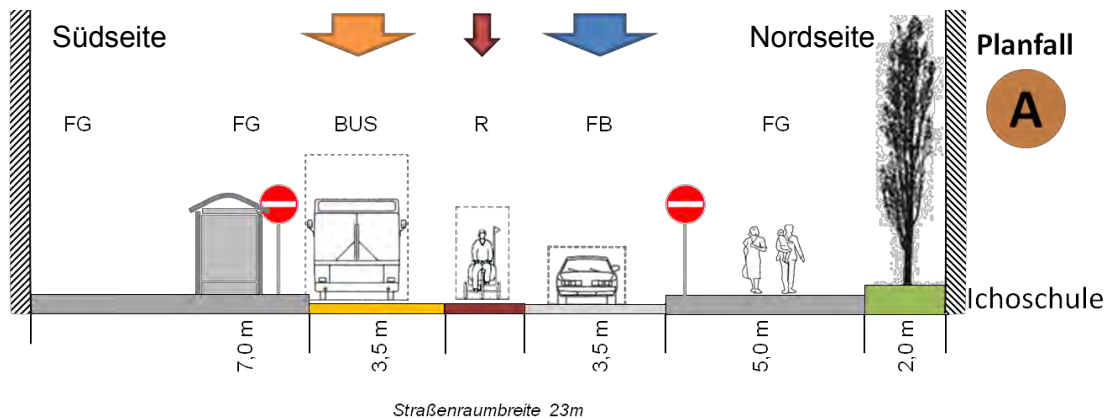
Mögliche Ummarkierung des Straßenraumes in der Silberhornstraße (Planfall A)
